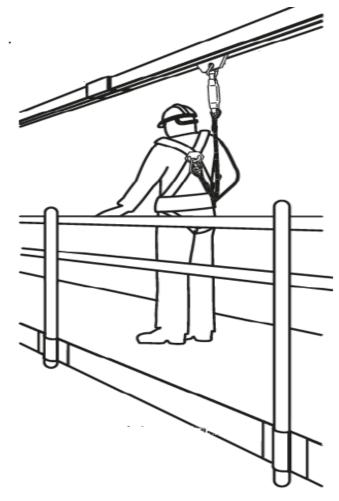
Tipo D – Exemplo de linha de ancoragem rígida horizontal. Fonte: NBR 16489
